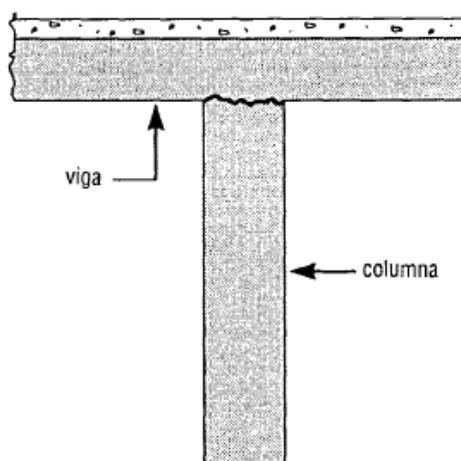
FISURAS DE JUNTA ENTRE COLUMNA Y VIGA
